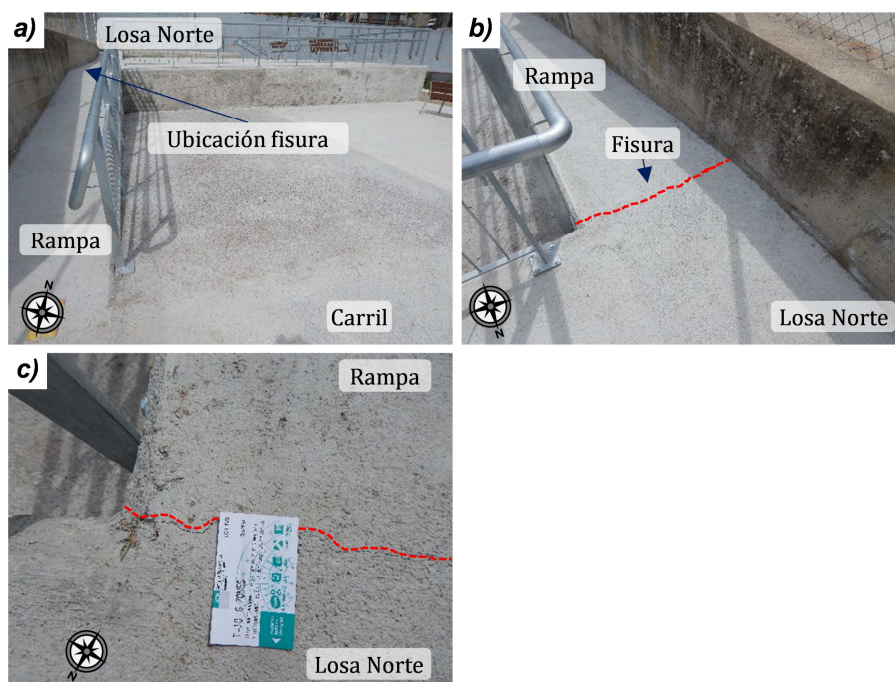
70 – a) Vista general; b) Localización de la fisura entre la losa norte y la rampa; c) Detalle de fisura
